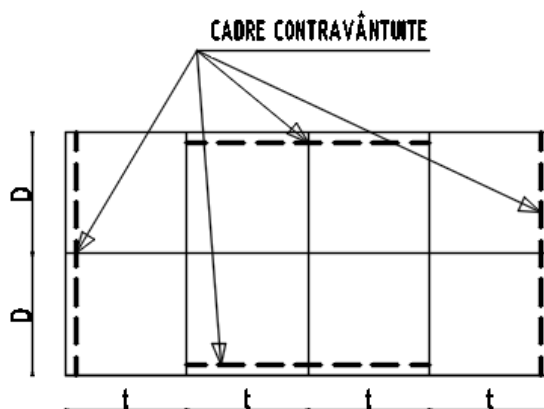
Amplasarea în plan a cadrelor contravântuite
